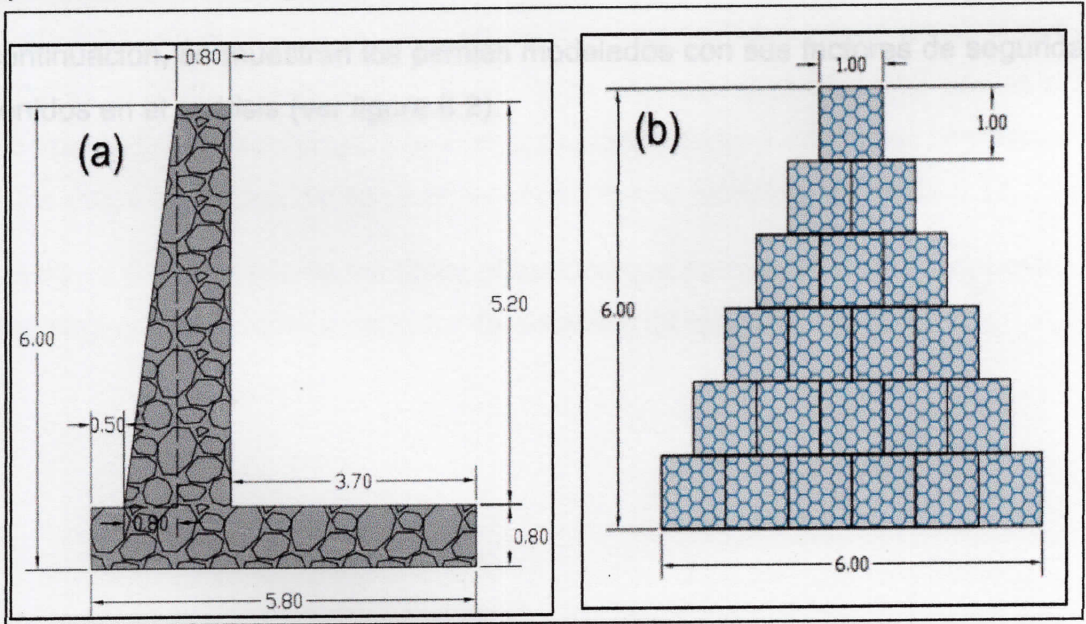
(a) Gráfico sección transversal Muro en voladizo, (b) gráfico sección transversal Gavión.
